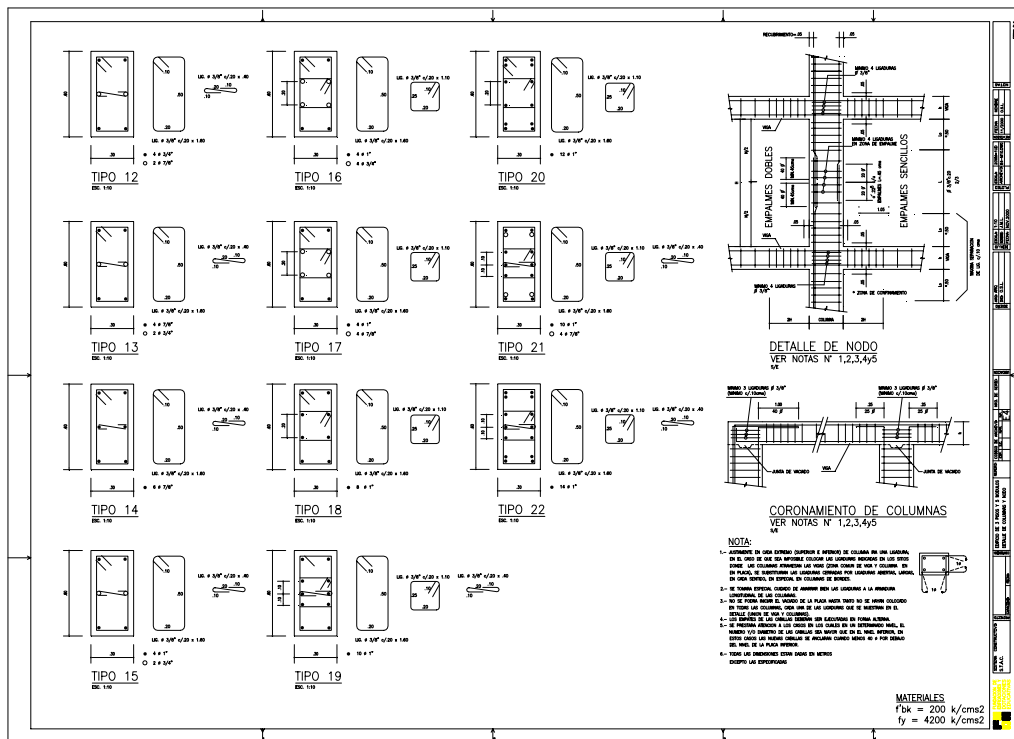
Detalles de columnas y nodo. Tipo STAC
